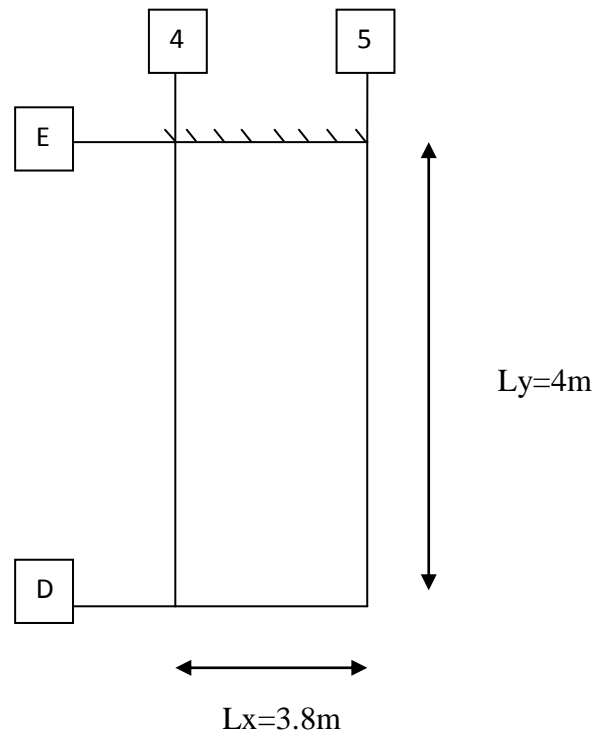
Schéma de ferrailage du plancher d'étage
